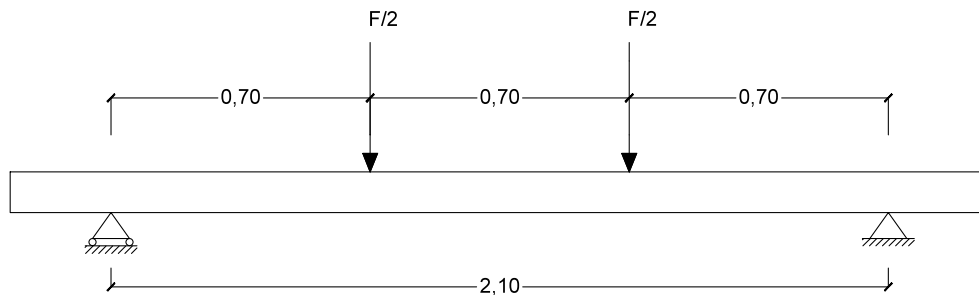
Disposição das vigas para ensaio (medidas em m).
